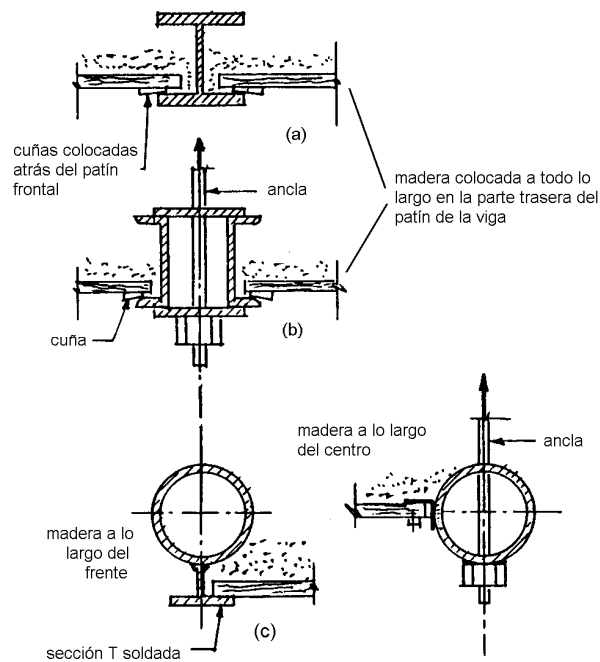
, Diversos tipos de pilotes para muro Berlín (a) con viga I o H; (b) sección en canal; (c) con tubo de acero, Xanthakos (1994)
